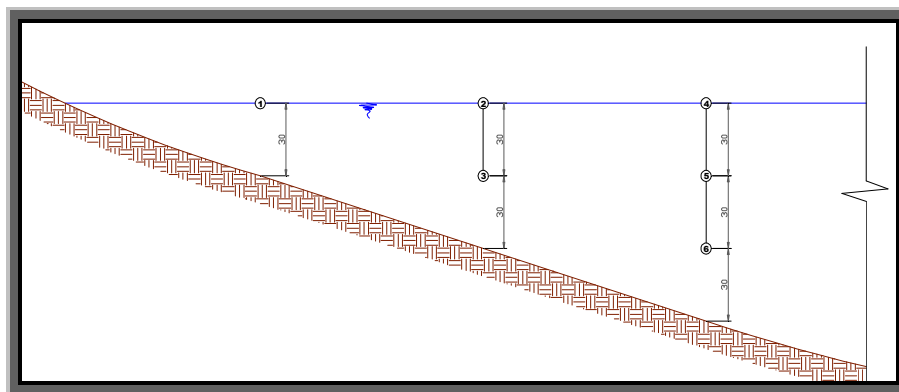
Primer perfil transversal utilizado para hacer la primera campaña de prueba de los instrumentos
